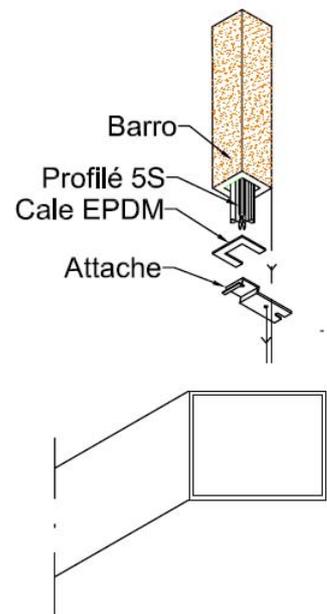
a – Pose verticale, partie courante, Barro à fleur (profil de section rectangulaire)
